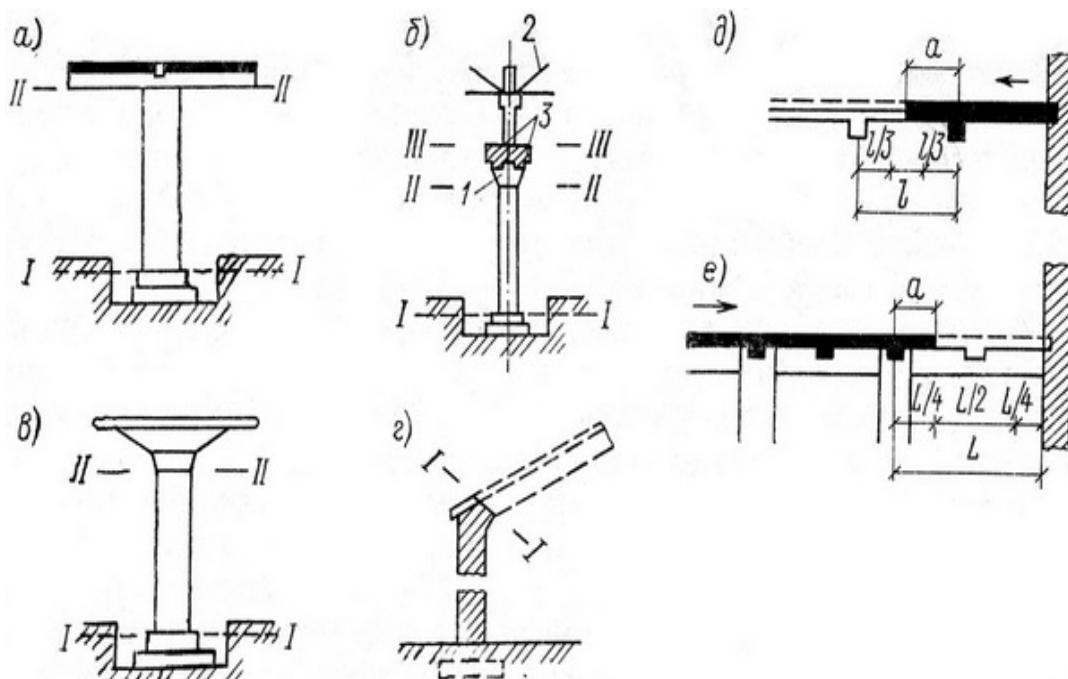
Расположение рабочих швов при бетонировании конструкций:
